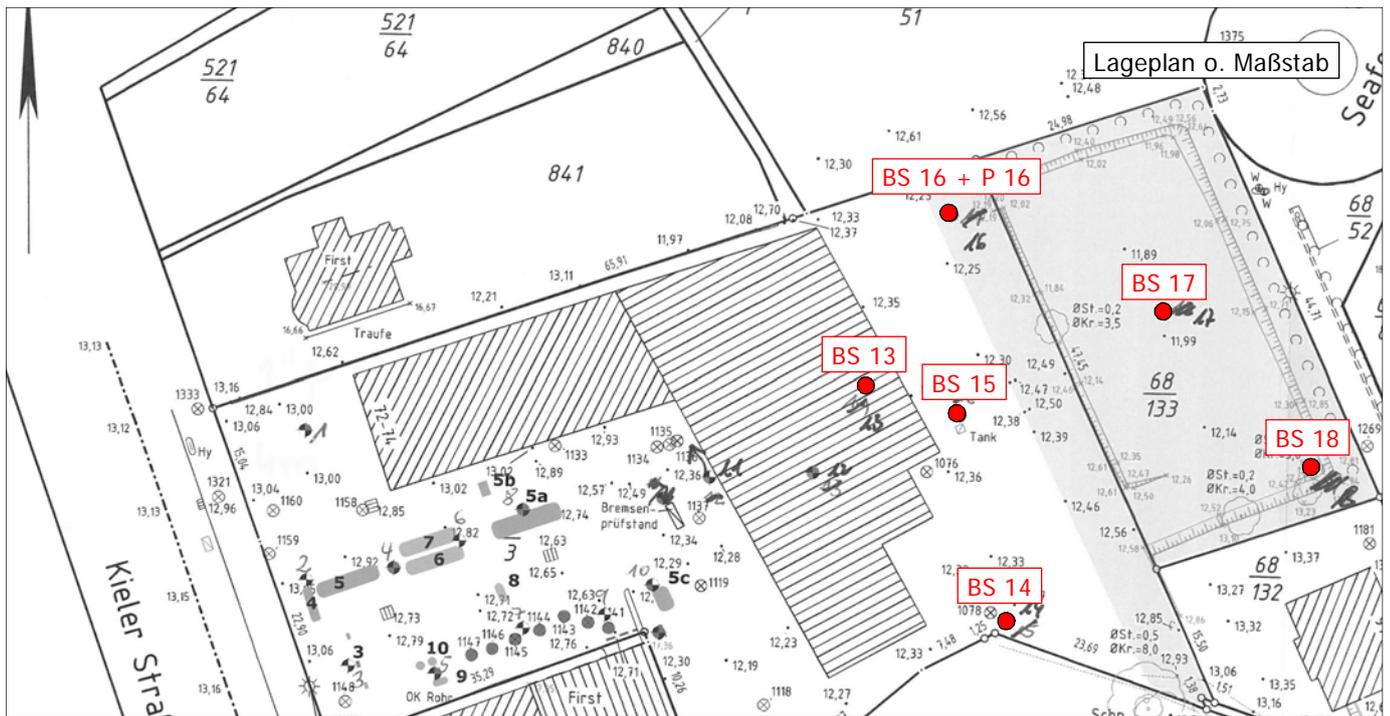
Lageplanausschnitt, Anl. 1.2 (o. M.)
